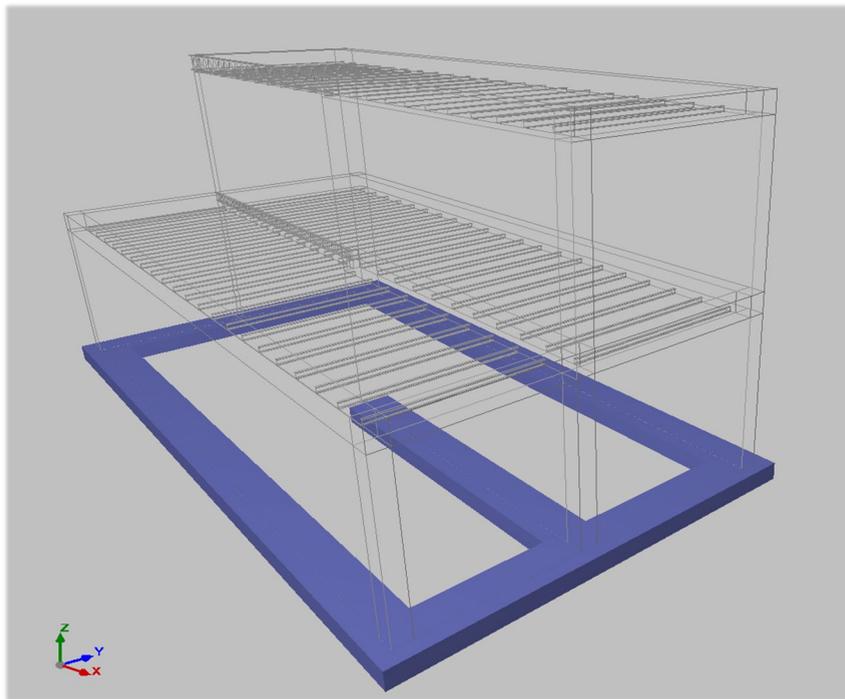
Perspectiva 3D de cimentación. Cype. Elaboración propia
